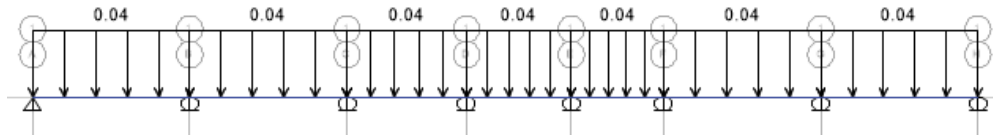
Carga viva distribuida en vigueta de losa aligerada
